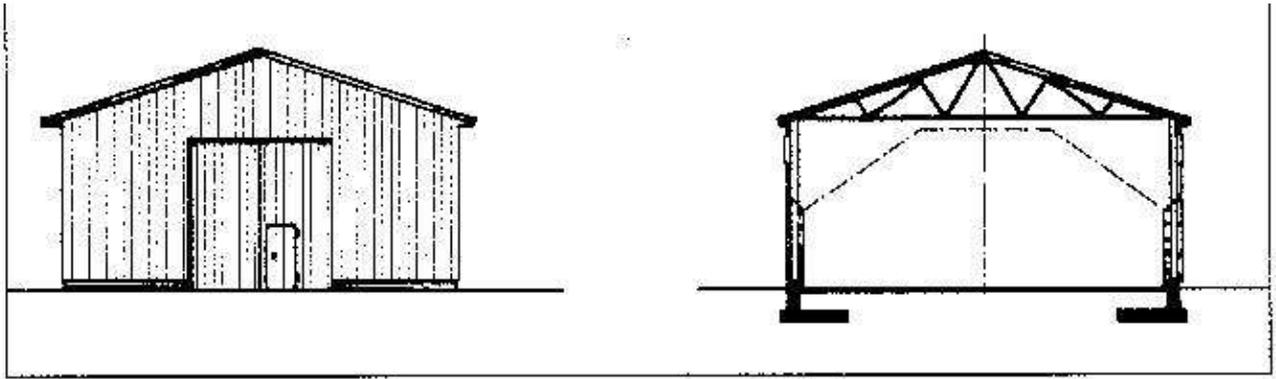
Streugutlagerhalle (Werkbild Holzbau Holten)
